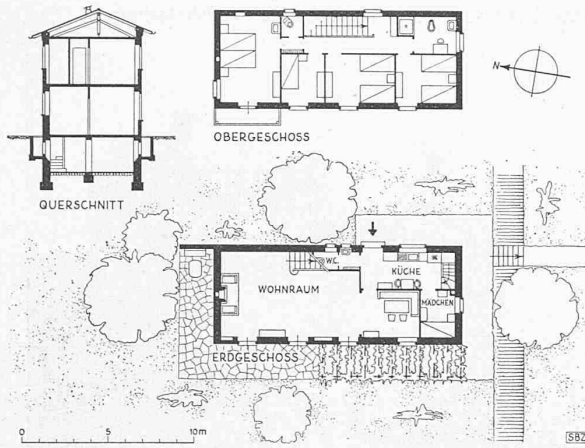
Grundrisse und Schnitt 1 : 400 des Ferienhauses in Vira-Gambarogno
